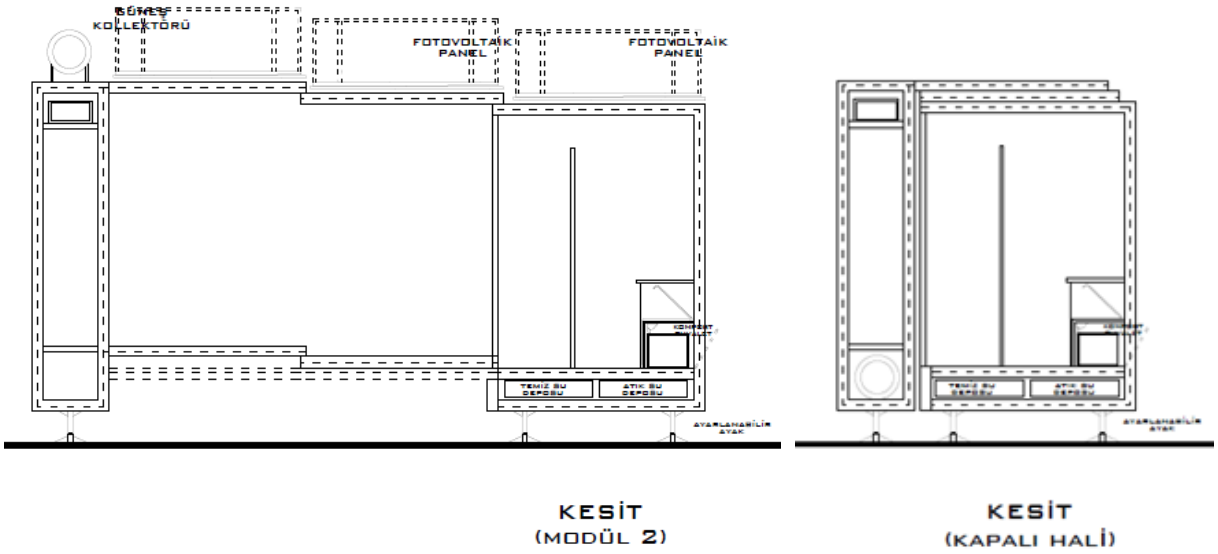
Birimlerin kapalı halini ve açılışını gösteren plan çizimi.
